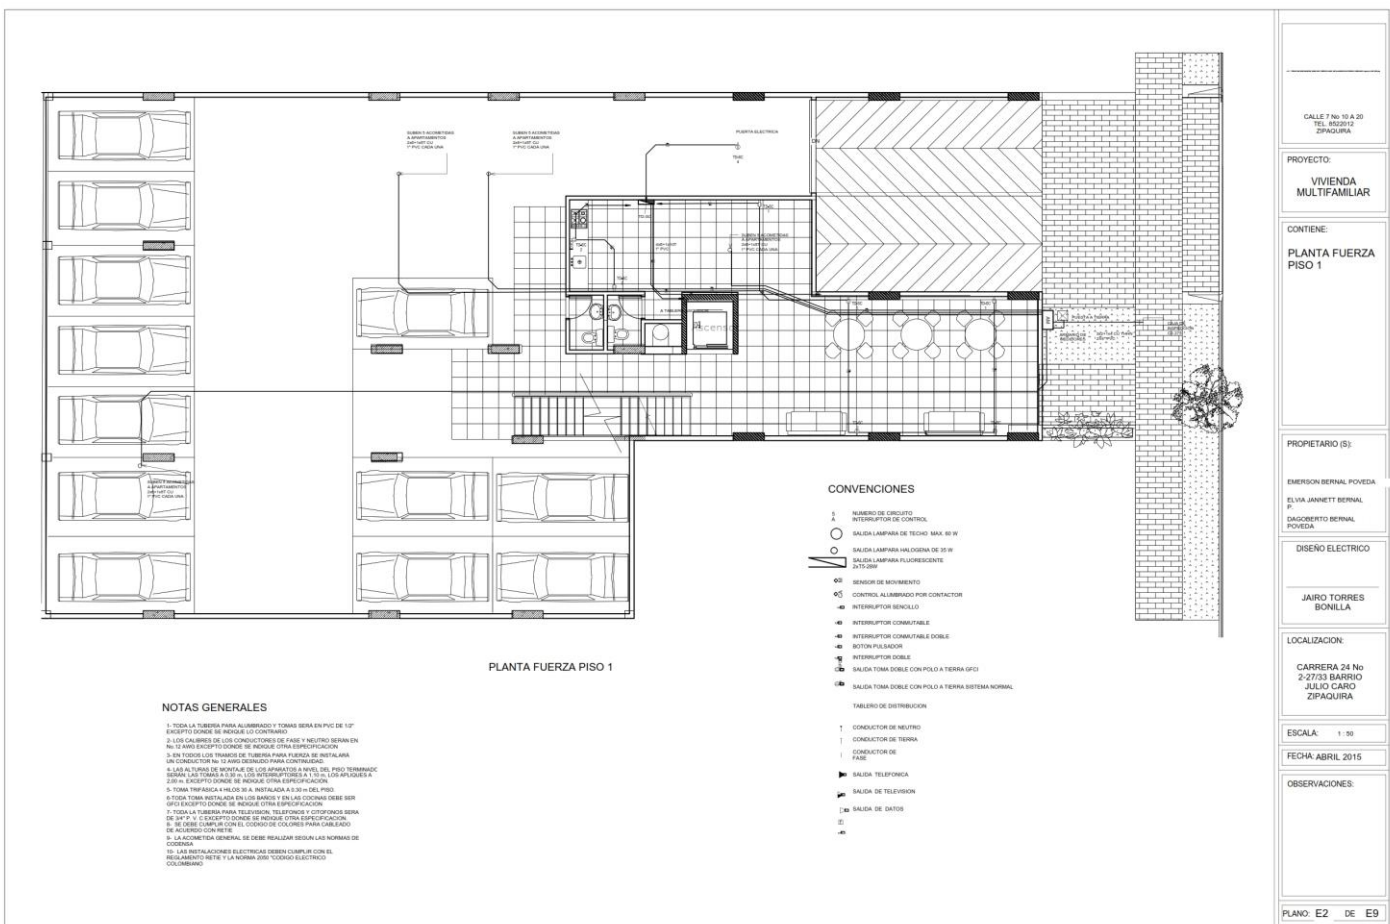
Planta de fuerza semisótano edificio Rodamonte
